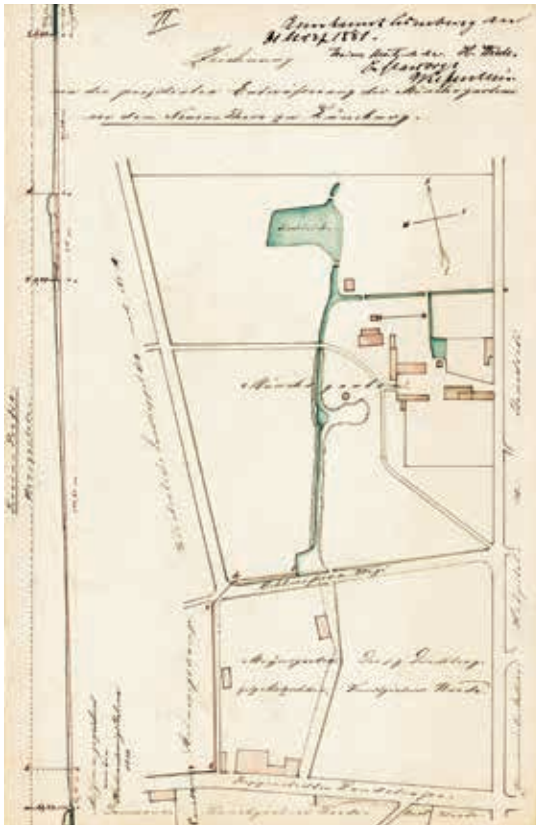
Entwässerungsplan, 1881 (StAL – KRA 494)
